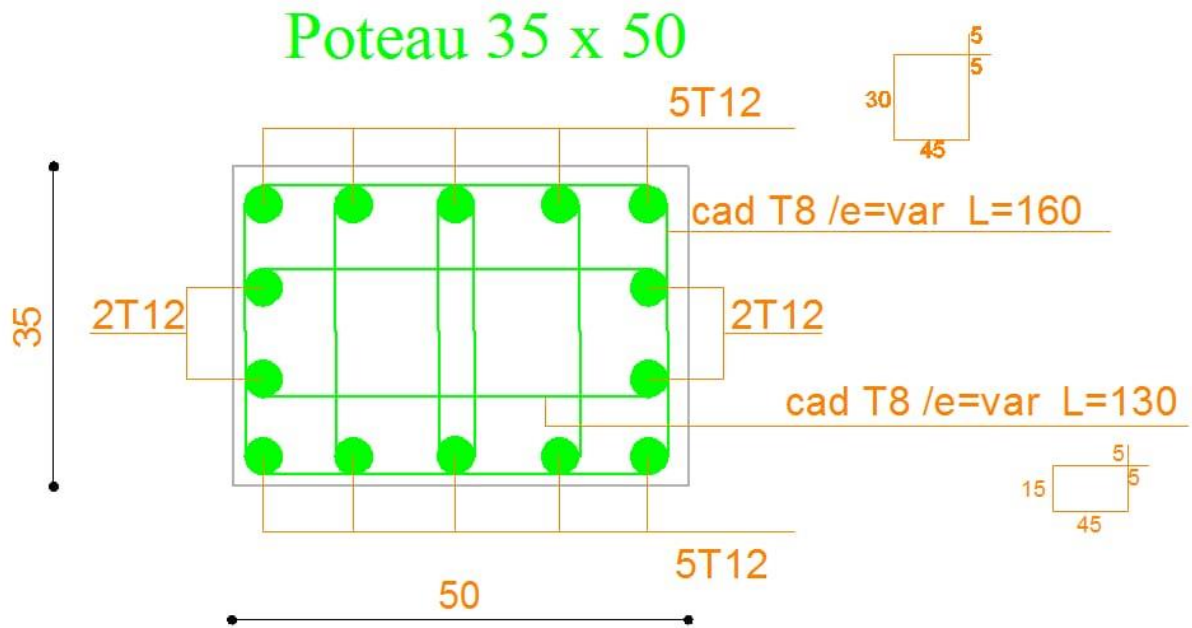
Schéma de ferrailage des poteaux 35x50.
